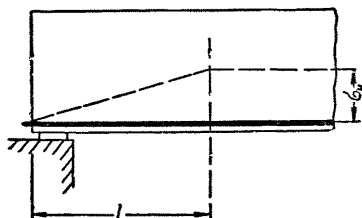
Схема распределения предварительного напряжения по длине холоднотянутой проволоки (без анкеров) после обжатия бетона
